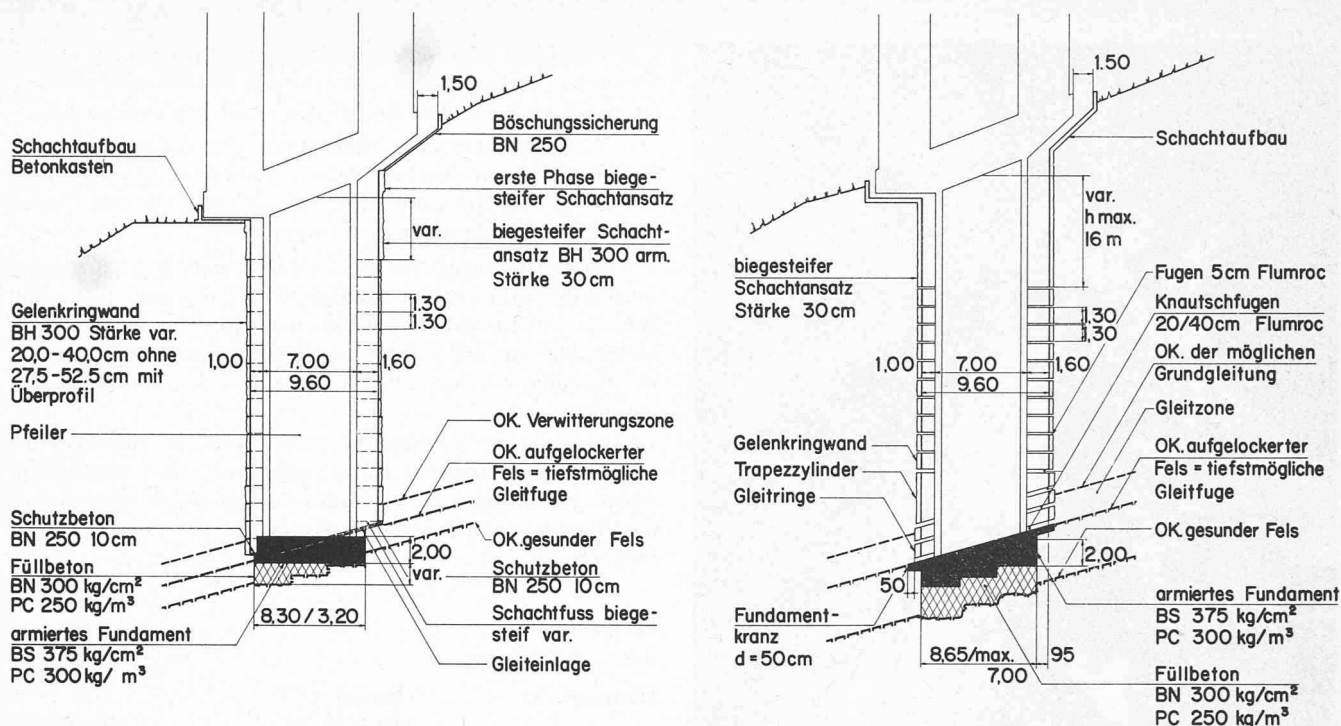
Schachtkonzept und Fundation. Vergleich Wettbewerb und Ausführungsprojekt
